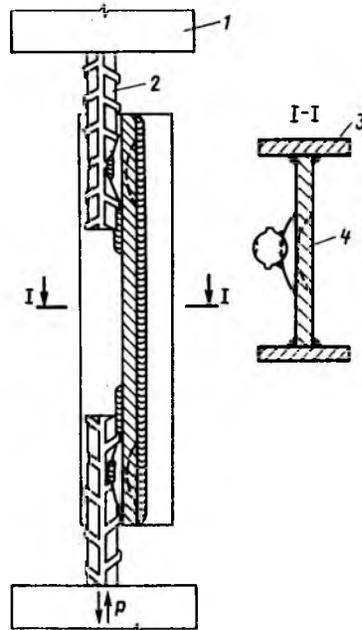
Опытный образец с двумя нахлесточными соединениями, выполненными контактной точечной сваркой по рельефу 1 — активный и неподвижный захваты нагружающего устройства; 2 — арматурные стержни; 3 — ребра жесткости; 4 — пластина с рельефом
